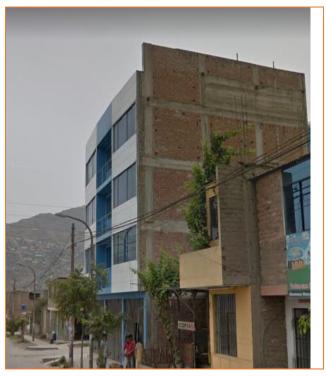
Edificación de albañilería con muros inestables segundo nivel. Fuente: Elaboración propia
